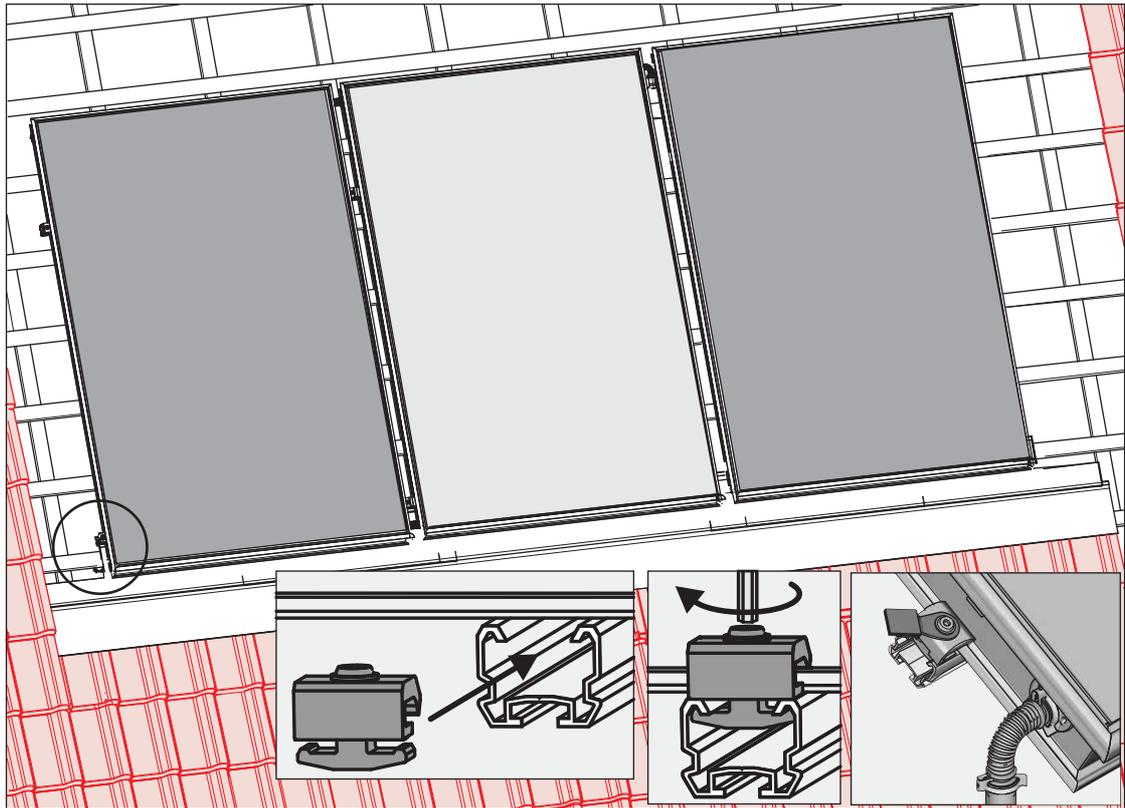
Insérez et serrez les coulisseaux simples pour le dernier capteur plan. Monter la pièce de blocage avec la borne de la liaison équipotentielle à proximité du raccord de retour. Représenté à l'exemple du capteur plan EKS<sub>V</sub>26P en système Drain Back
